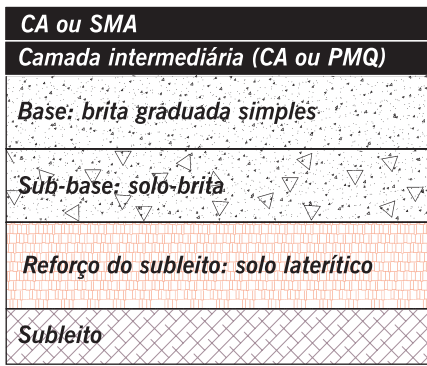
Estruturas típicas de pavimentos asfálticos
